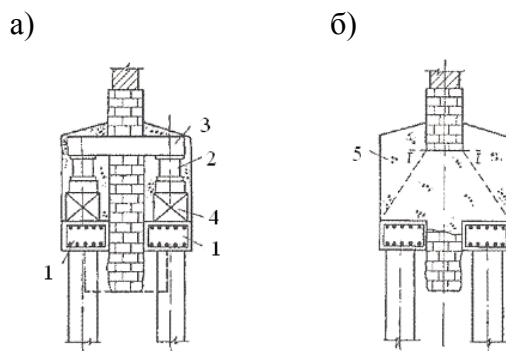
Усиления ленточного фундамента с полной заменой его свайным фундаментом:
